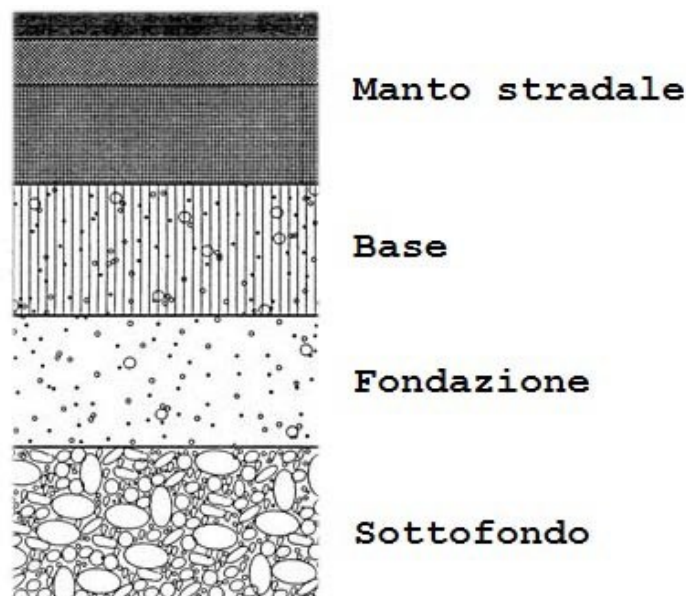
stratigrafia di un pacchetto strutturale di una pavimentazione stradale flessibile
